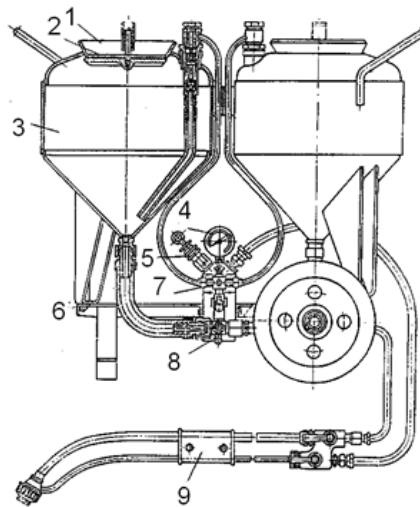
Установка для нанесення рідкої шпаклівки
